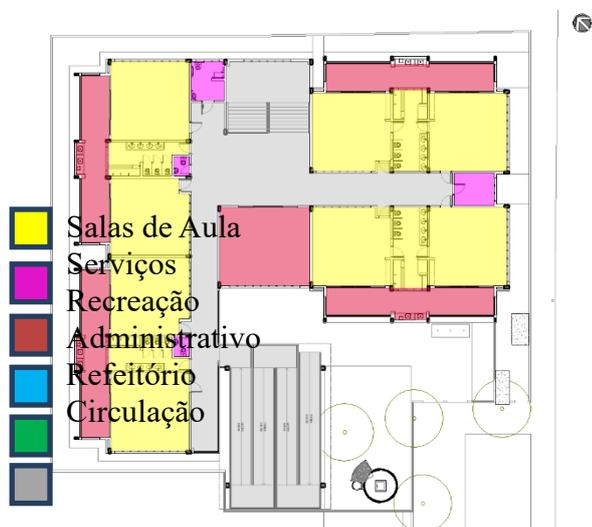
Setorização pavimento superior (elaborada pelo autor – imagem 12.12.2019)
